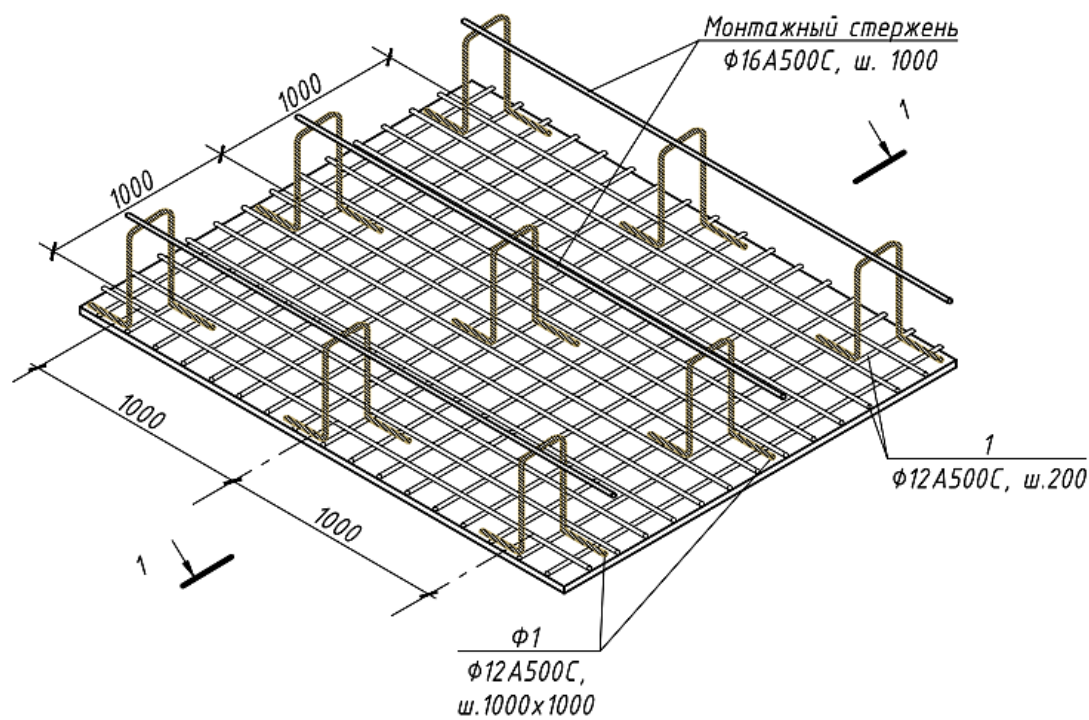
Схема устройства фиксаторов арматурных стержней
